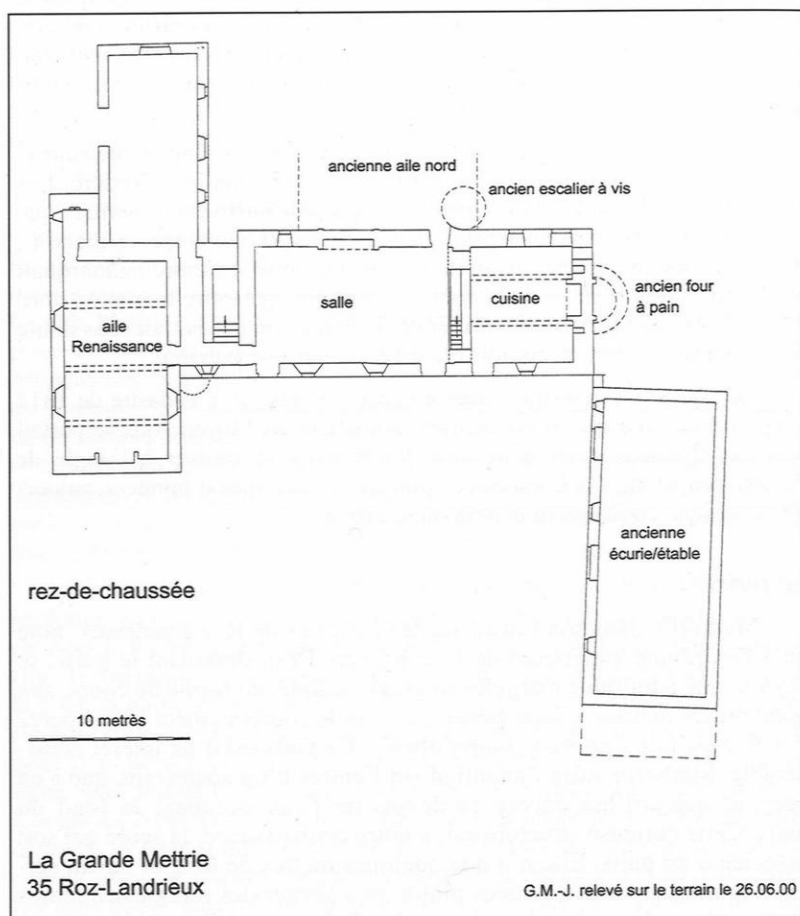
La Grande Mettrie : plans (rez-de-chaussée).
